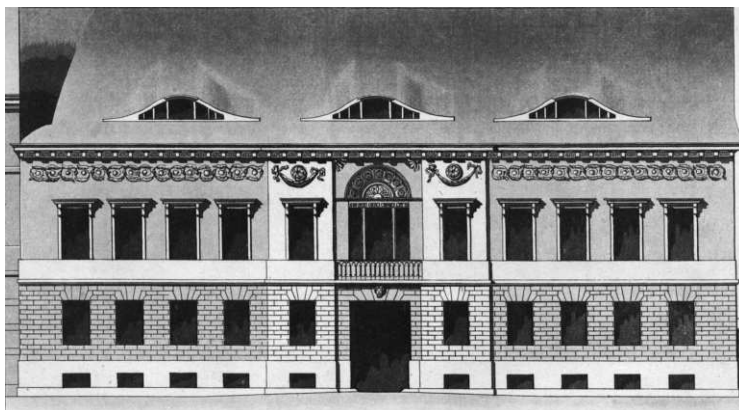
| Friedrich Gilly: Stadthaus Behrenstraße 68, Berlin (1800);
